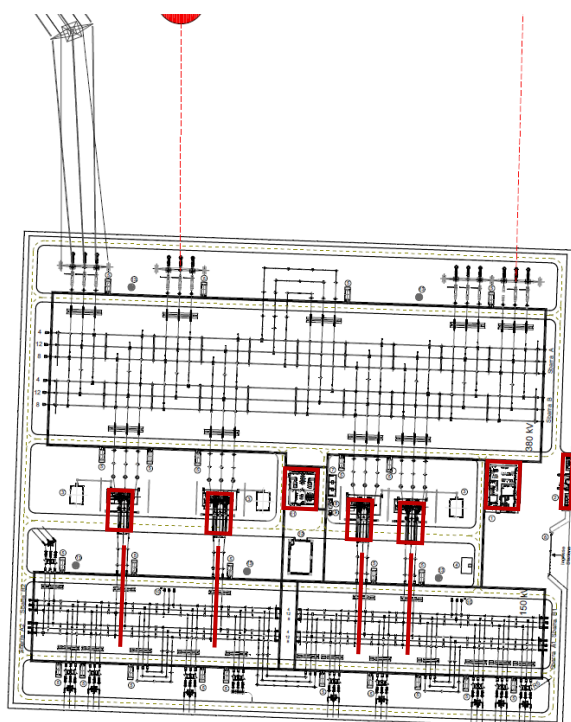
Planimetria della stazione elettrica di connessione e fine elettrodotto – evidenziate le sorgenti principali.
